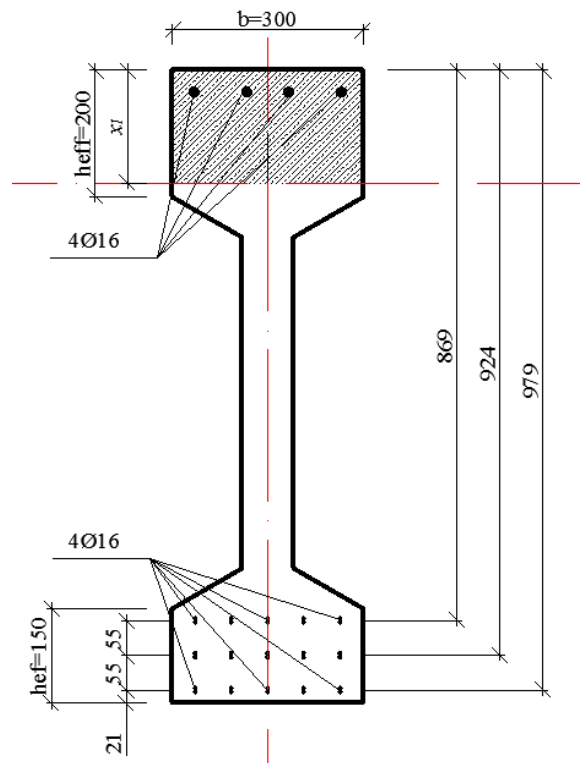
Схема розрахункового перерізу для розрахунку за першою групою граничних станів
